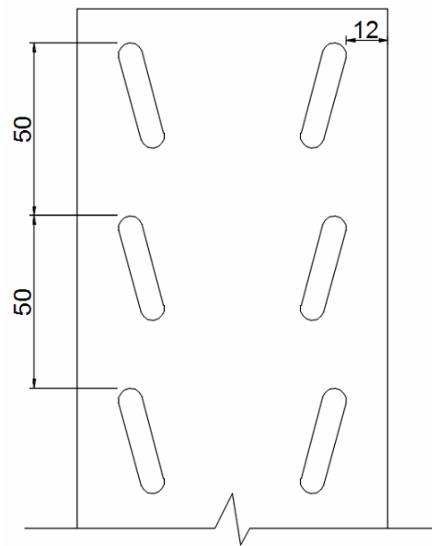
Espaçamento padrão utilizado nas perfurações inclinadas (mm).
